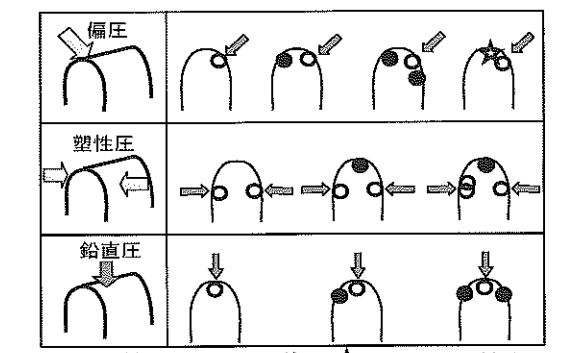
偏圧、塑性圧、鉛直圧の「ひび割れパターン」例
